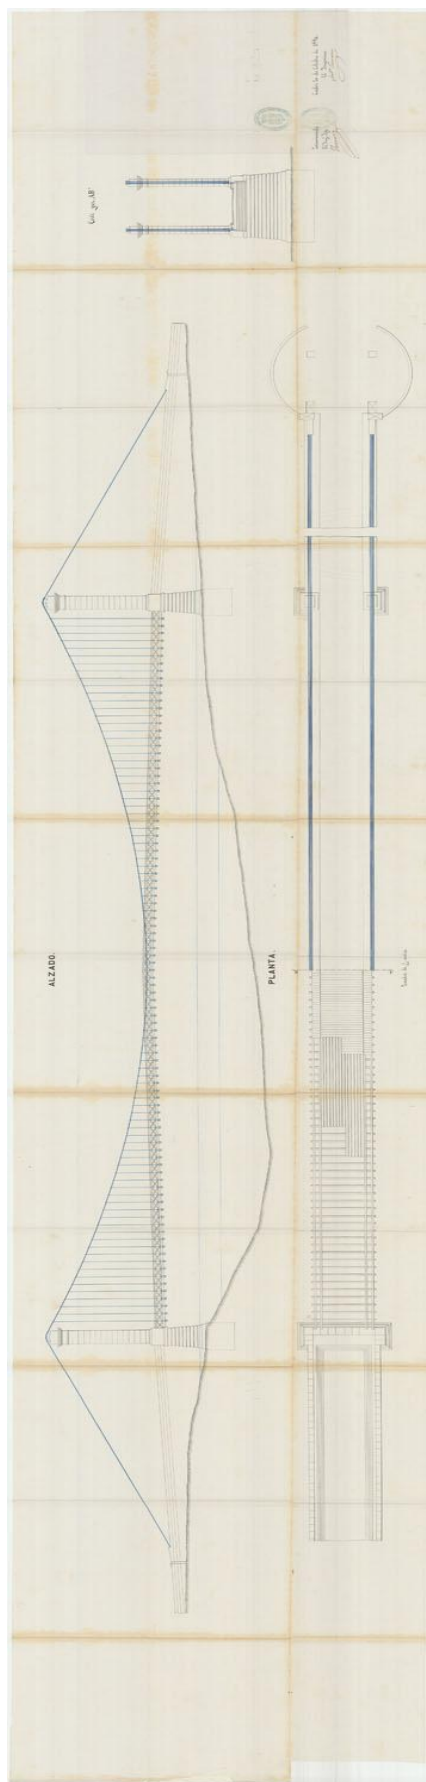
Alzado, planta y corte transversal de un puente colgante sobre el río Guadalete. Cádiz, 20 octubre de 1880. Antonio Carmona.
